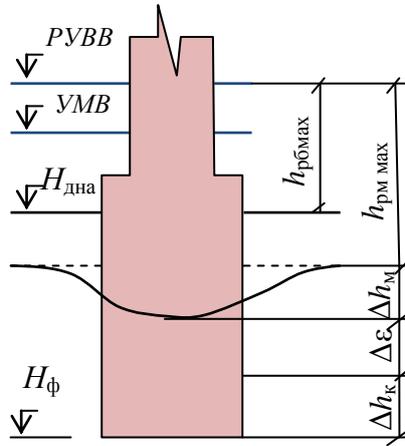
Схема к определению минимальной отметки подошвы фундамента
